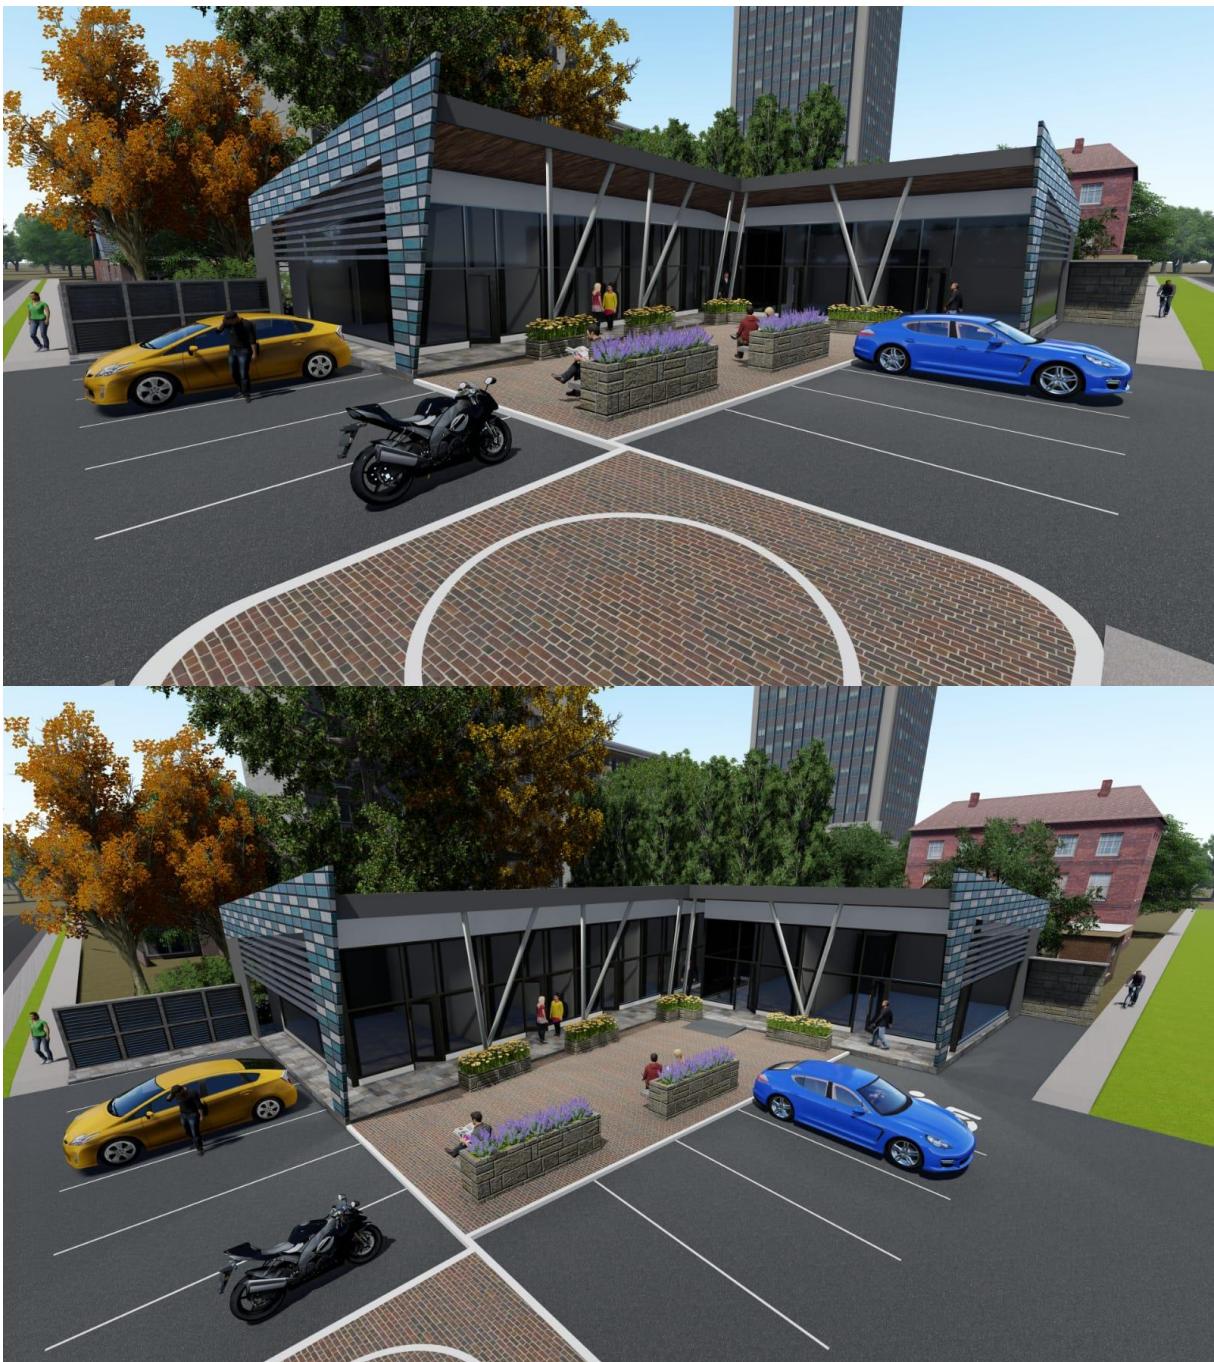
Render de la plaza a Construir. Fuente: Empresa Promotora.
